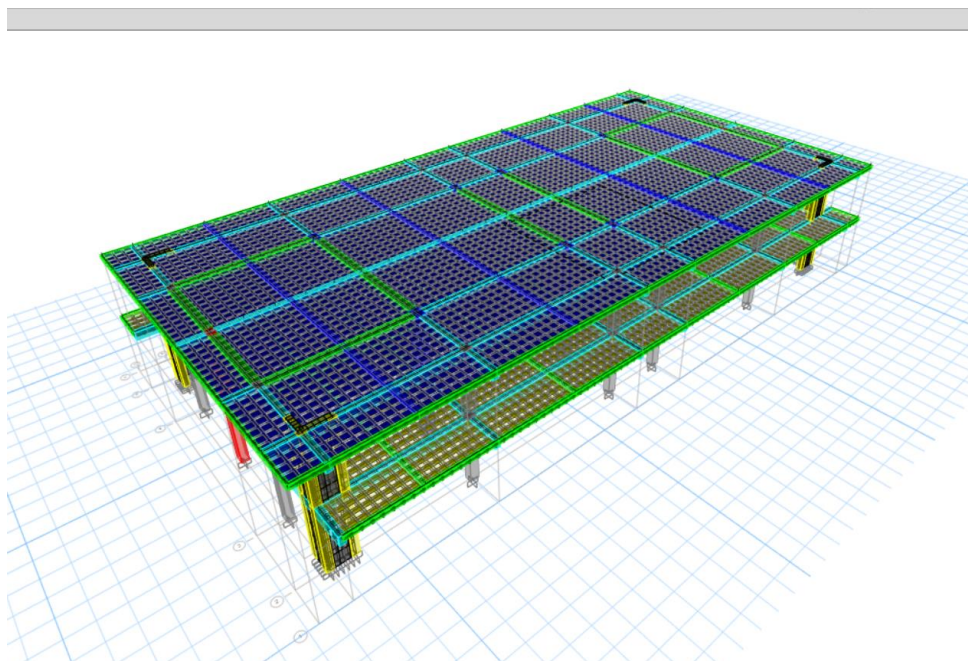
Vista en 3D del sistema estructural de hormigón armado
